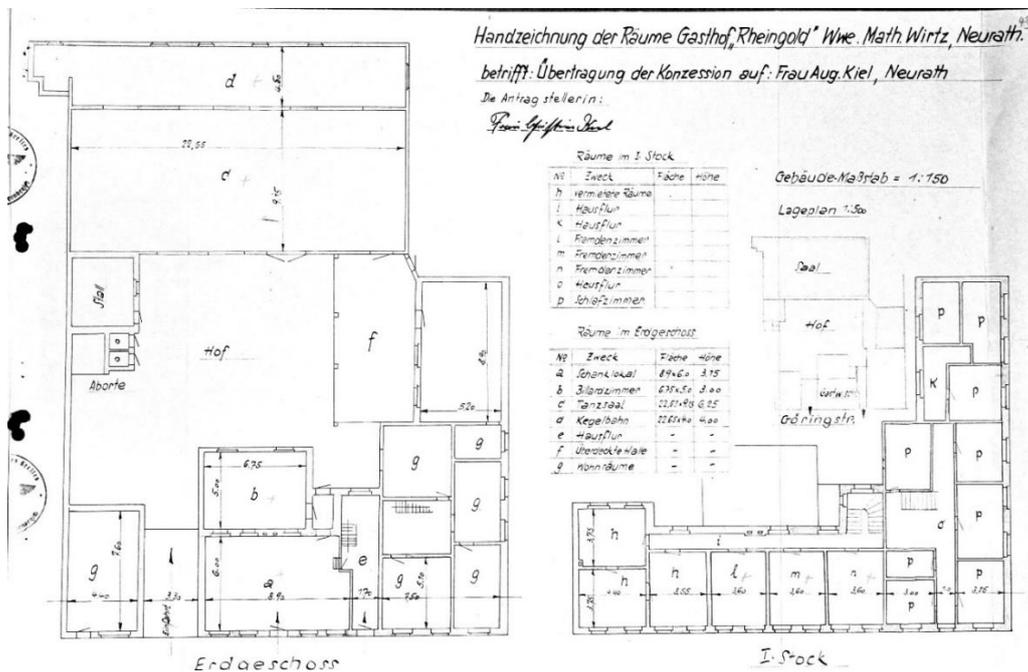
Grundriss (um 1936) des Gasthofes Rheingold, links: Erdgeschoss, rechts: 1. Etage²⁵
